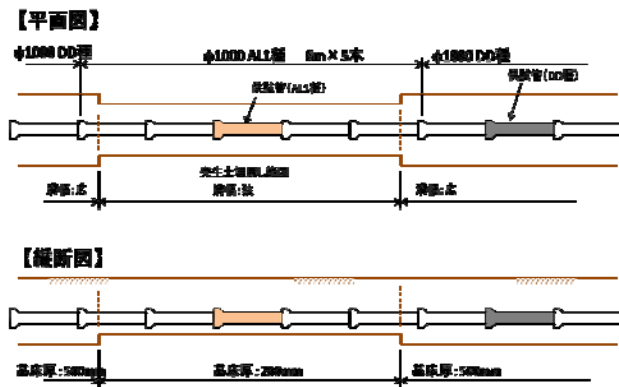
AL1種及びDD種の施工範囲（平面・縦断面図）
